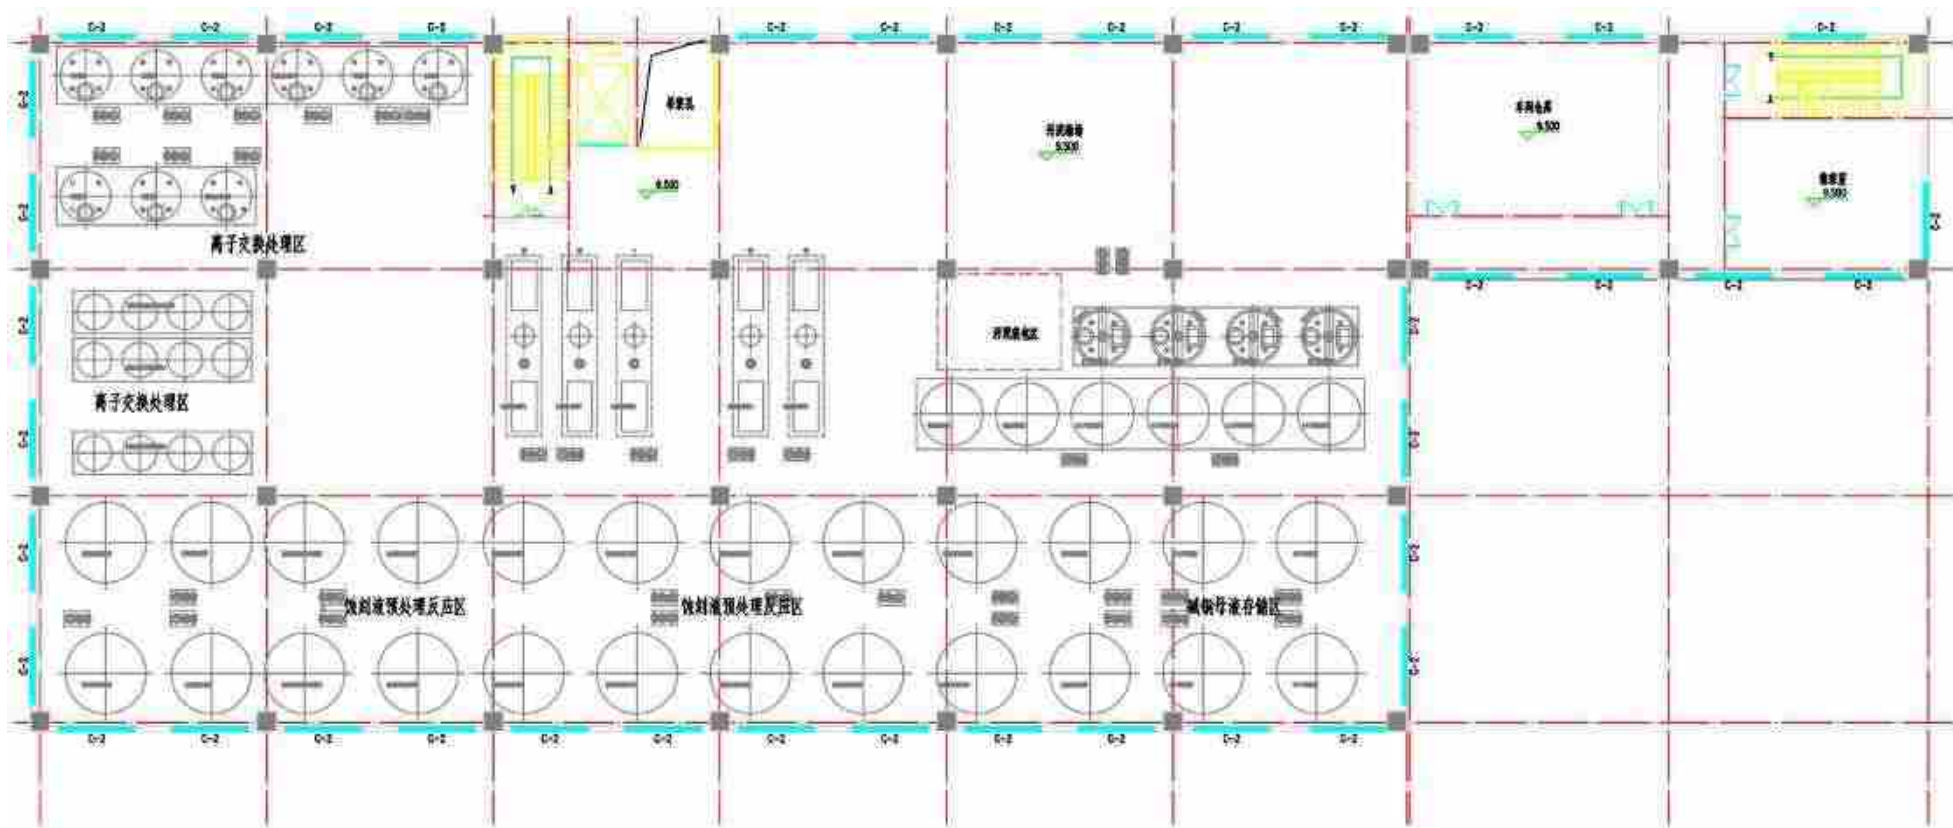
(2) 本次改扩建后 7#\*厂房 2 层平面布置图
